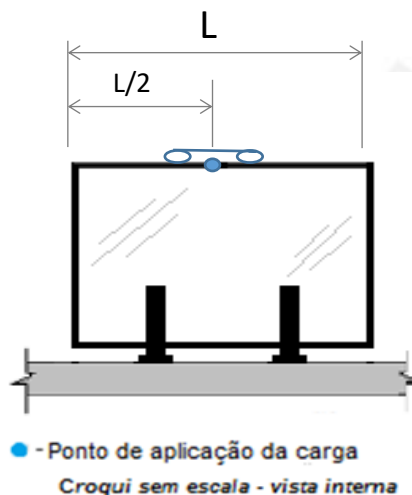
Croqui de localização do ponto de leitura da deformação e aplicação da carga
